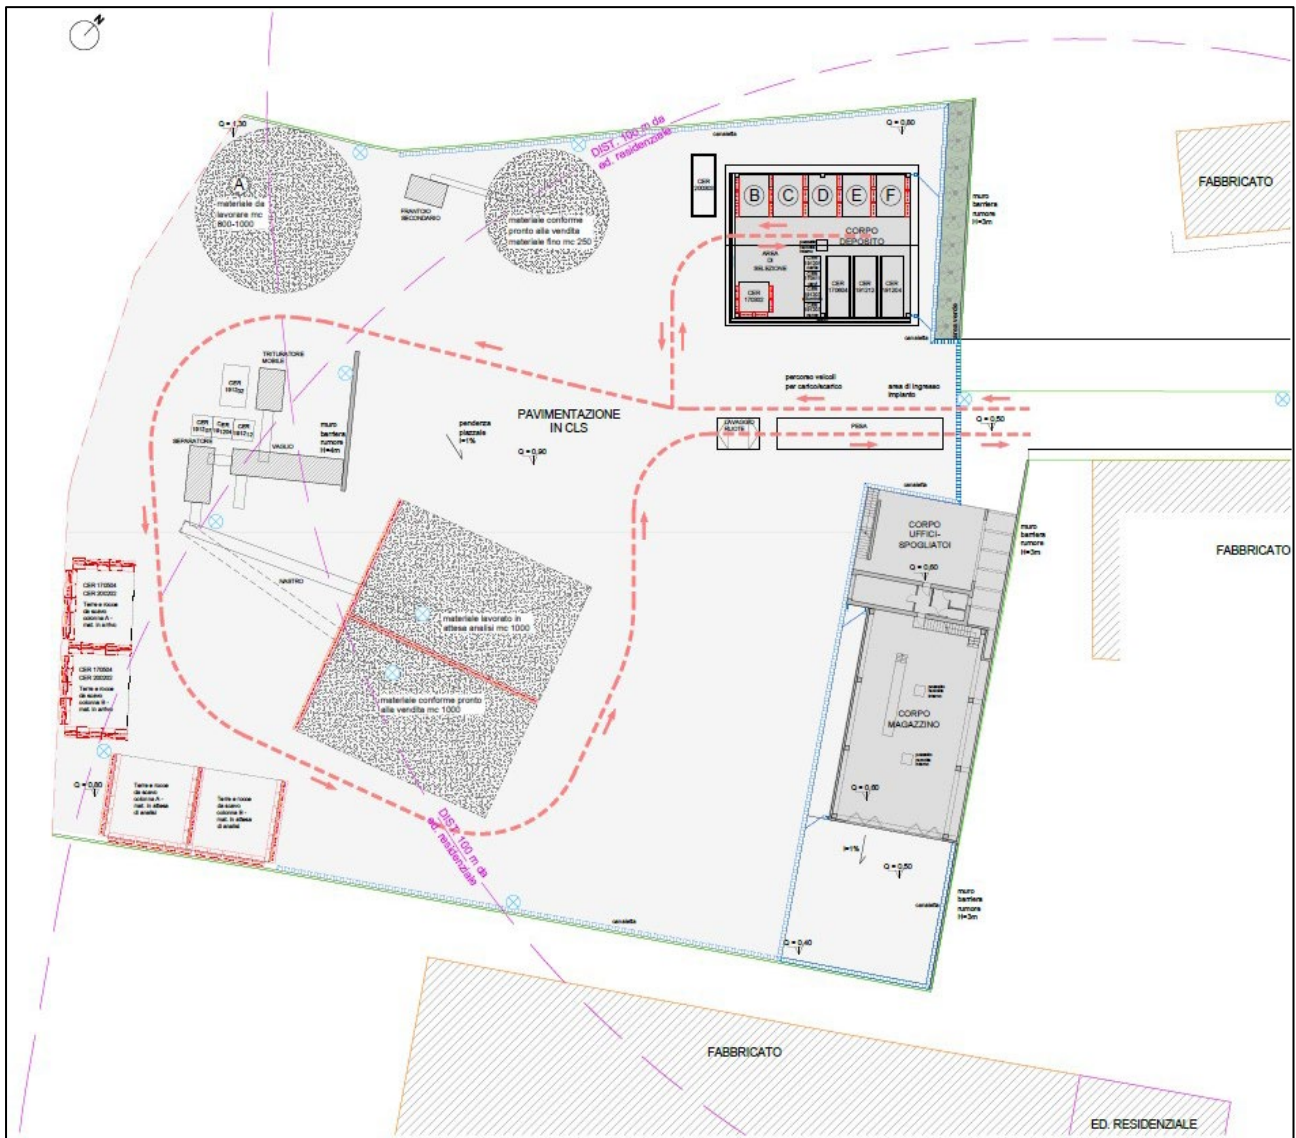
Estratto Allegato 2.2 allo SPA - Layout impianto – Distanza di 100 m dalle civili abitazioni tratteggiata in rosa
